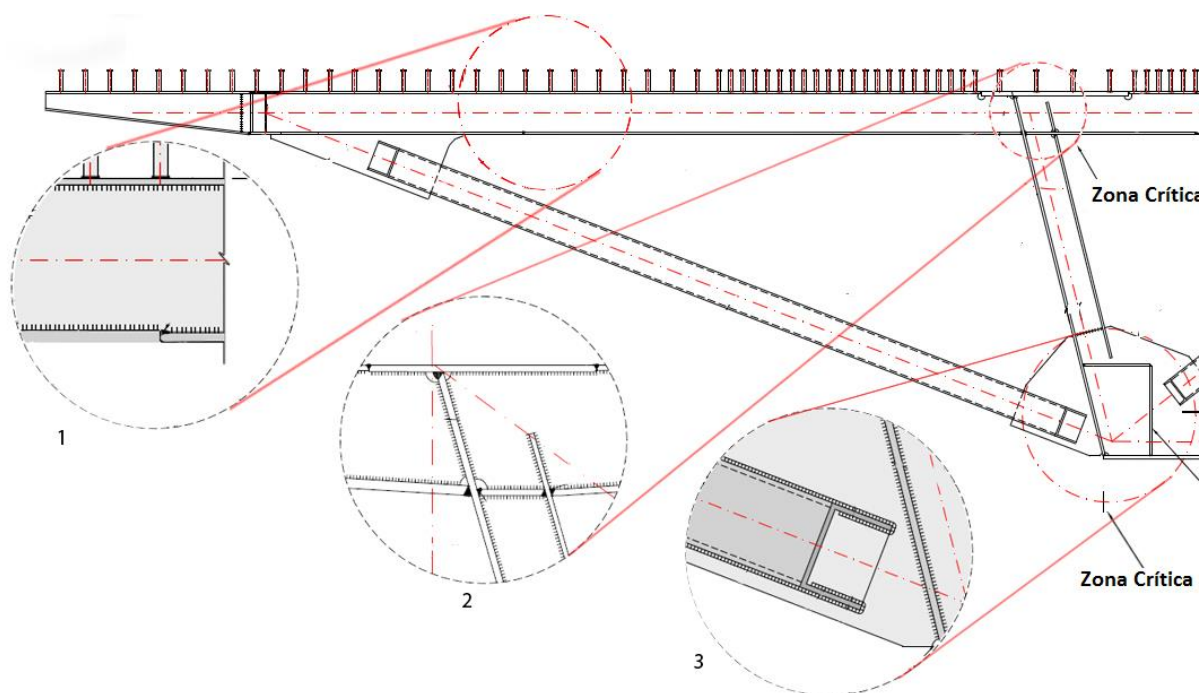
Zonas críticas da tipologia seccional em caixão com travessa superior escorada
